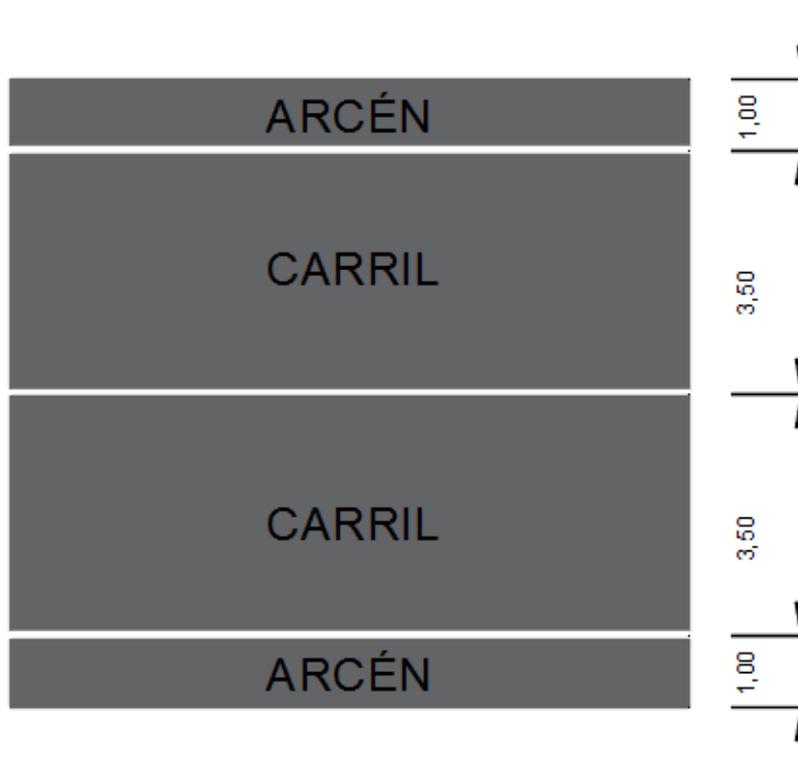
Sección transversal tramo montaña (medidas en metros). Fuente: Elaboración propia.
